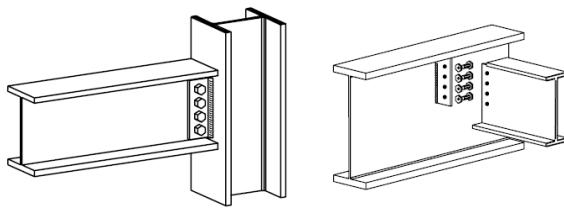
Ligação vi-pilar e viga-viga com placas de gousset (SCI/BCSA, *Joints in steel construction - simple connections.*, 2006) e adaptado de (Vieito, 2015)
